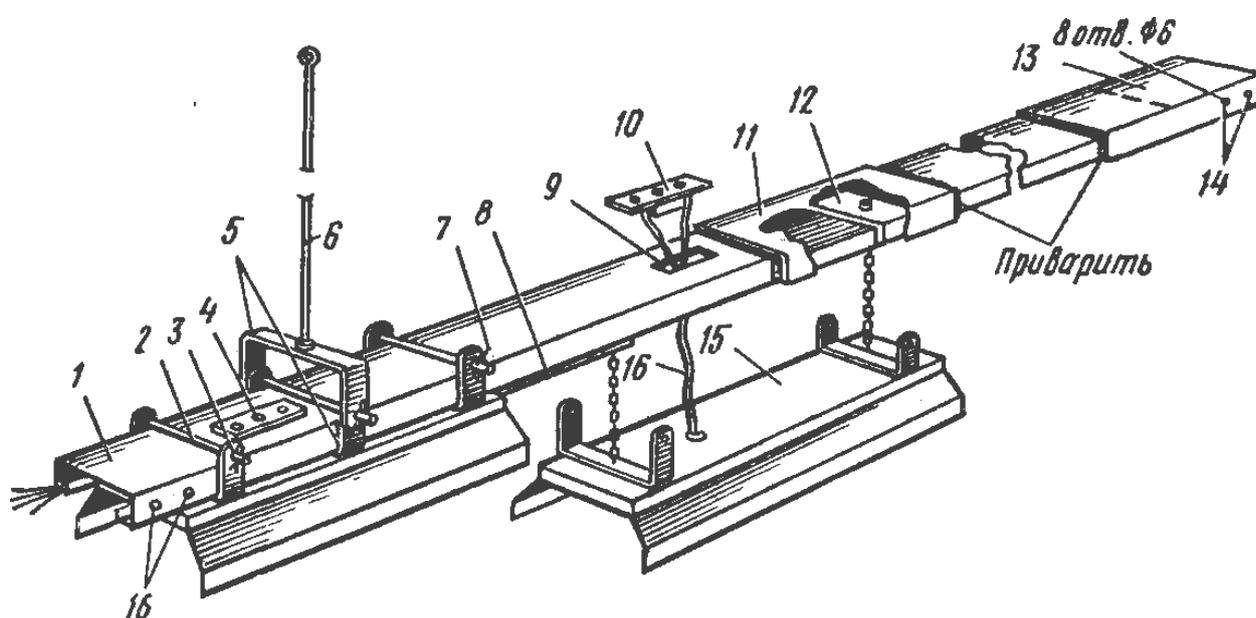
Подвеска светильников на коробе: 1 - секция короба; 2 - шпилька; 3 - скоба для крепления светильника; 4 - крышка монтажного отверстия; 5 - скоба подвески; 6 - подвеска; 7 - шплинт; 8 - крышка; 9 - монтажное отверстие; 10 - малогабаритный сжим; 11 - накладка; 12 - держатель с цепочкой; 13 - соединительная накладка; 14 - отверстия для соединения секций; 15 - светильник; 16 - провод
